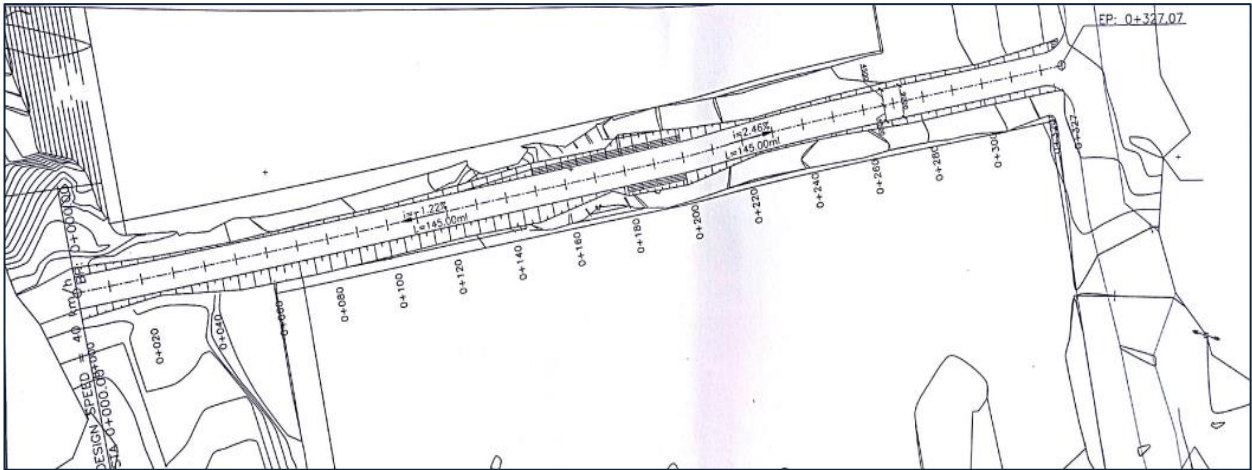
Levantamiento topográfico de los viales de la plazaleta.
